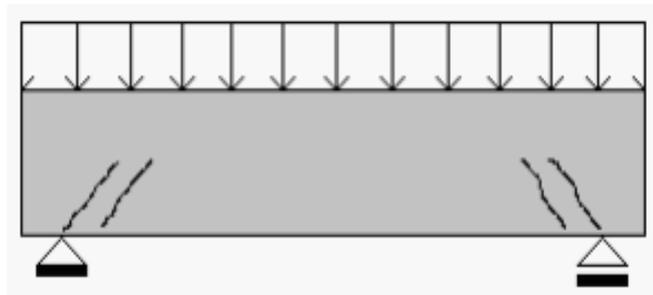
Fissura por cisalhamento em viga por flexão.
